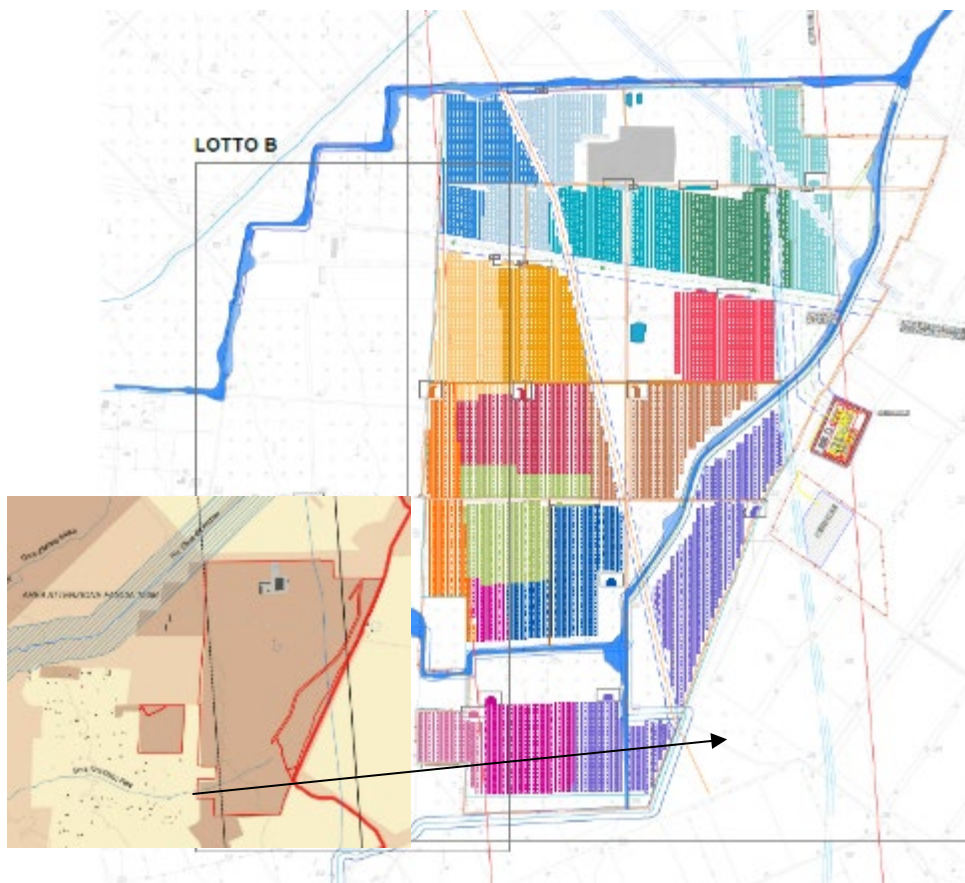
Layout di progetto (fonte: Tavola 11 A – Planimetria generale di progetto e nell'icona il vincolo paesaggistico dalla Tavola 4 A
